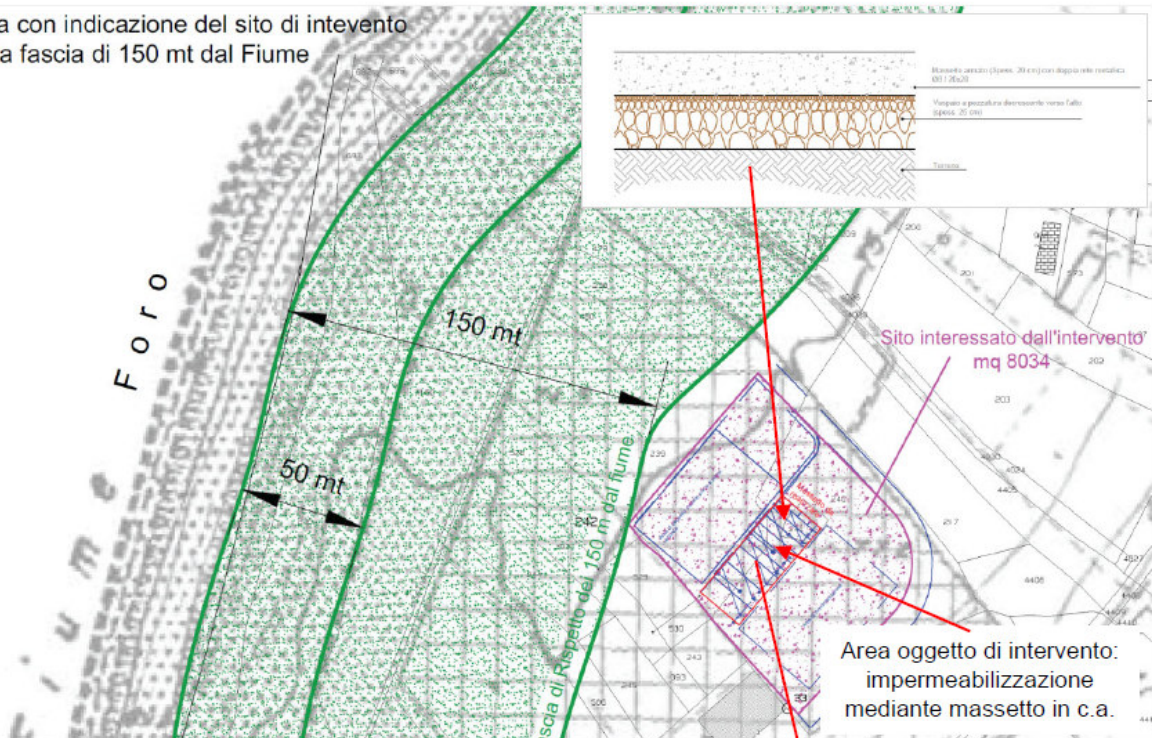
Ubicazione dell'area di intervento rispetto al Fiume Foro
